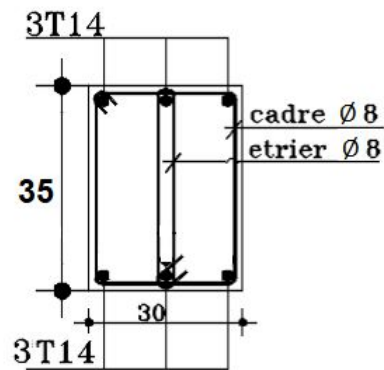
Ferrailage des poutres principales et Poutres secondaires
